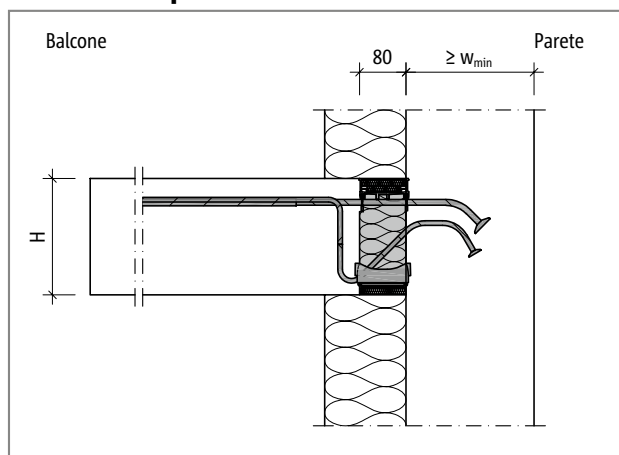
Schöck Isokorb® T tipo KL-O: raccordo alla testa della parete con isolamento esterno
